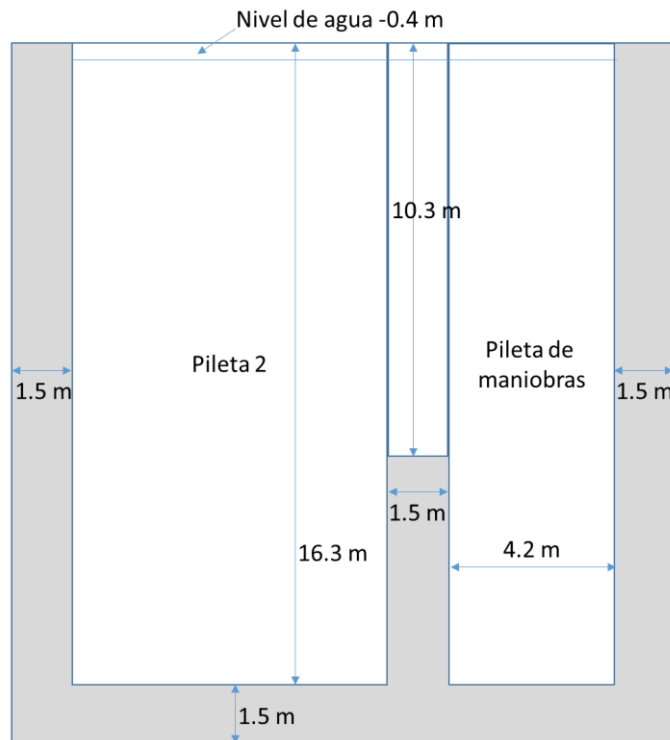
Esquema de las dimensiones de las piletas de la Casa de Piletas 1 (vista de costado, plano X-Z). Dimensiones extraídas del plano "M13-38"
